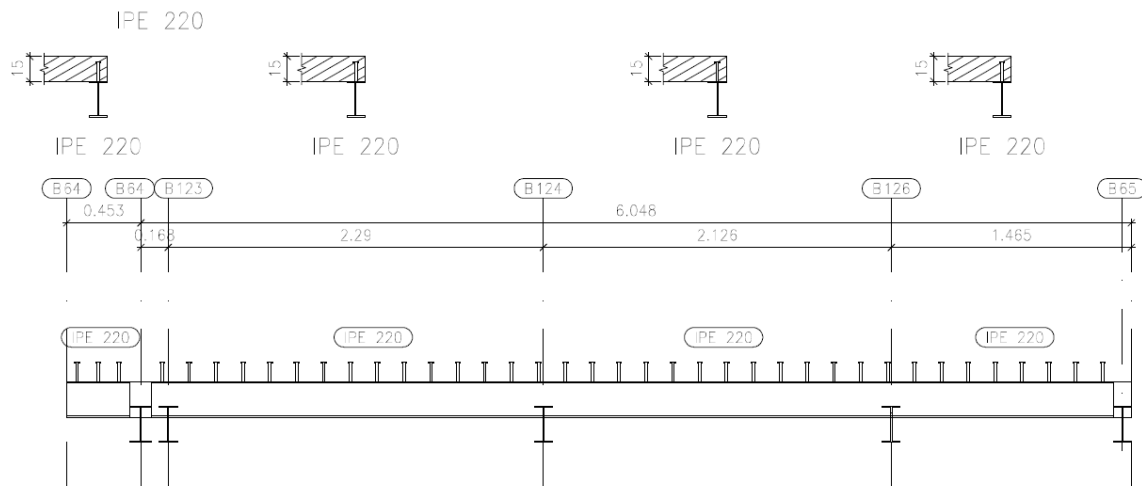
Especificaciones Vigas Entrepiso. Colegio. CAJAMAG.
